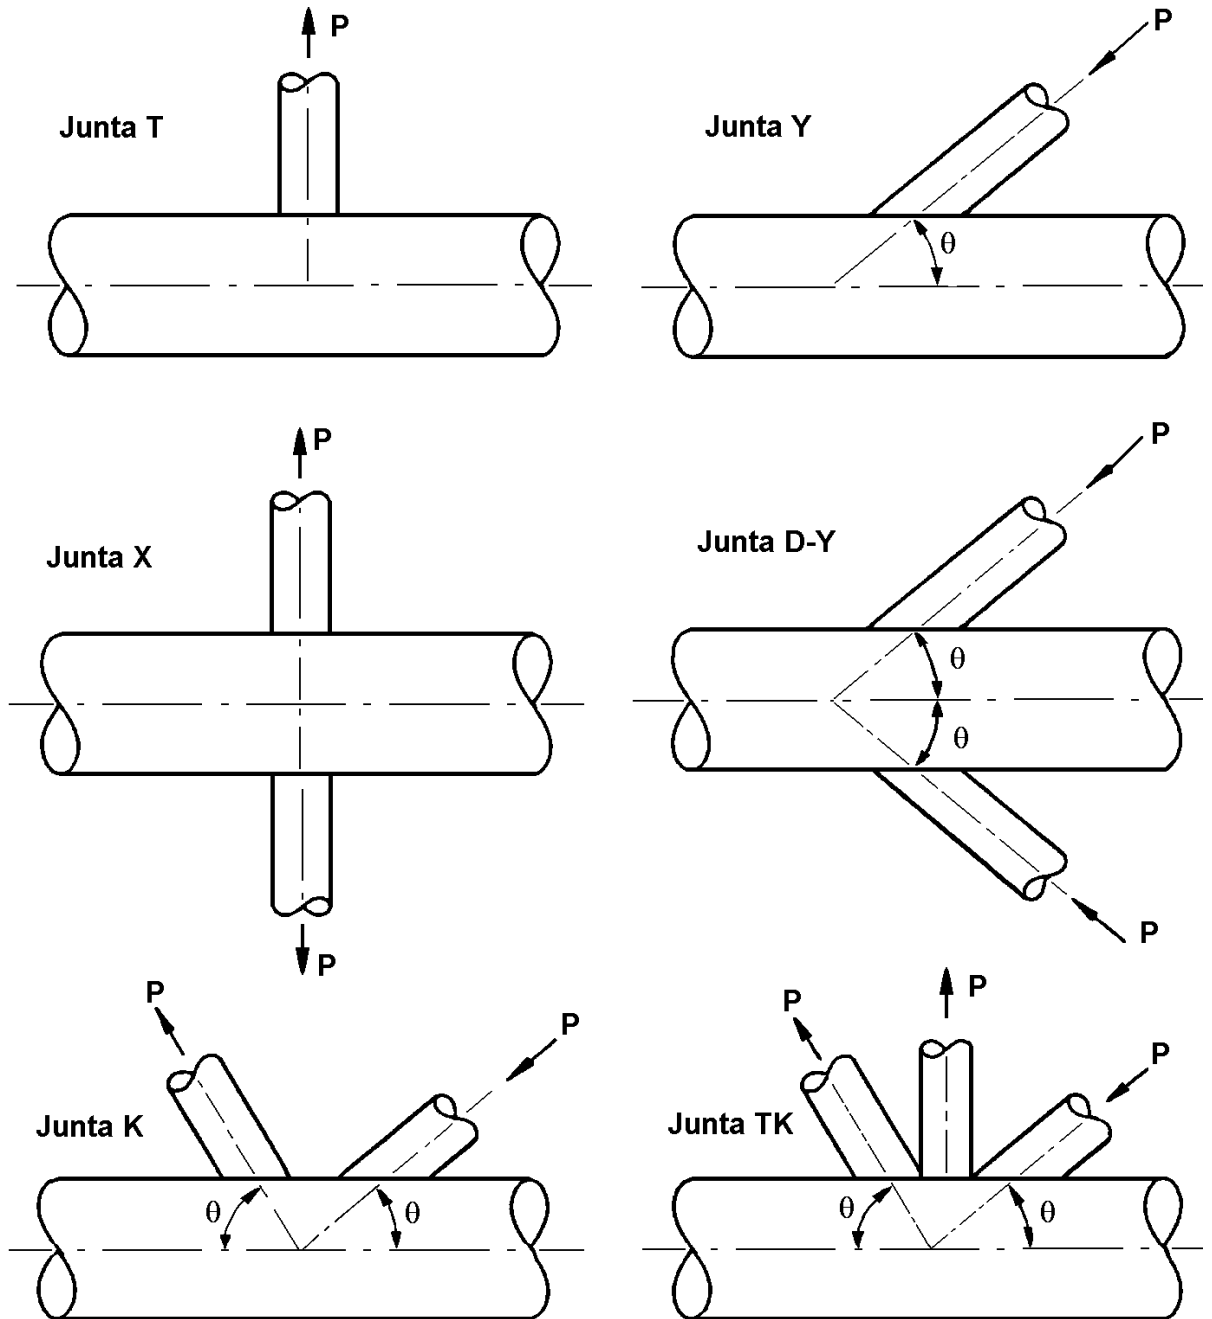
Juntas tubulares soldadas simples
